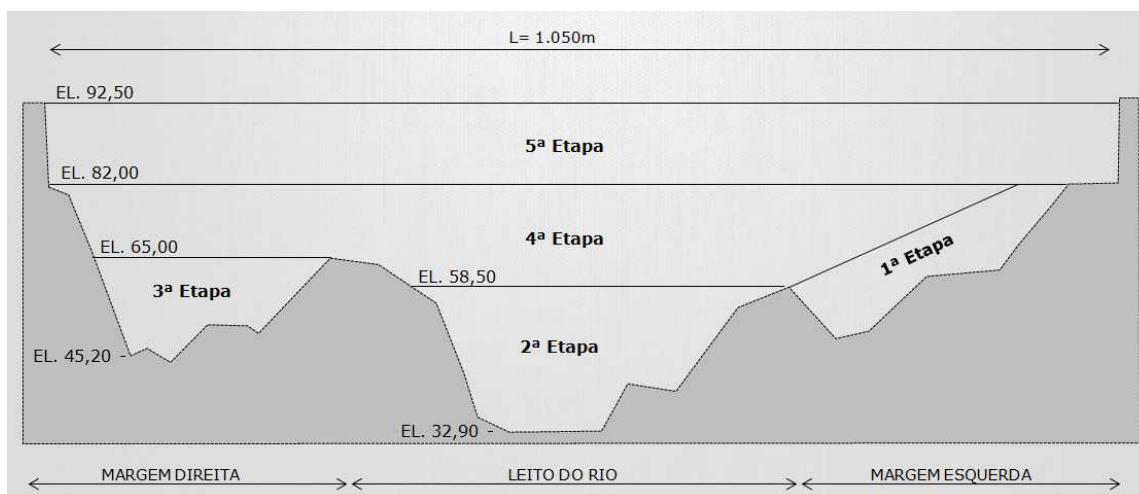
Seção Longitudinal Esquemática e Etapas de Construção - UHE Jirau (RAMALHO et al., 2013)
